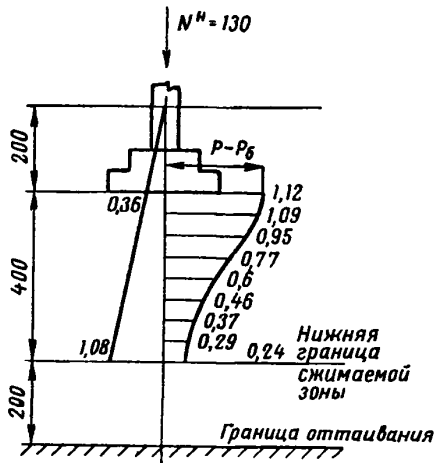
Расчет осадки фундамента на оттаивающих грунтах
